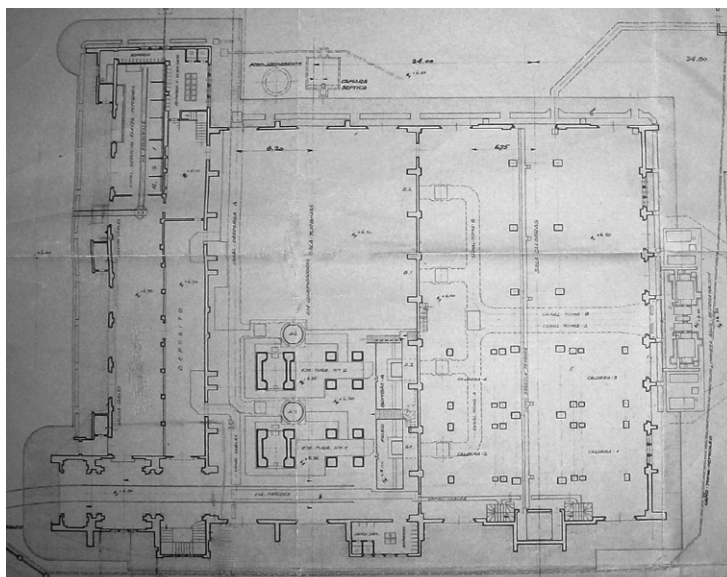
| Redibujado esquemático de la planta de la Usina Ingeniero White, luego General San Martín. Fuente: autoría propia.
